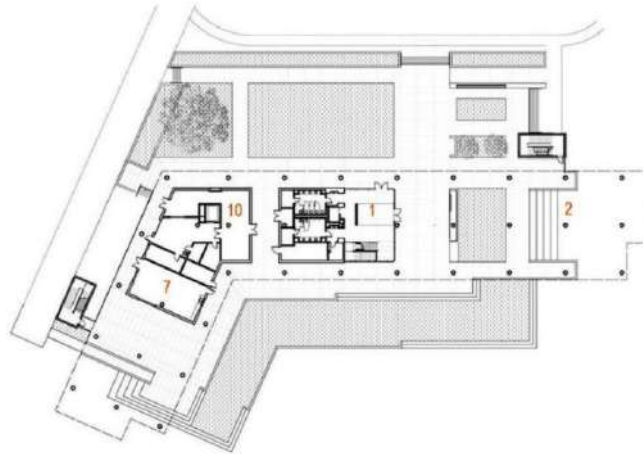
Penataan site plan bangunan UNC Coastal Studies Institute (CSI)
